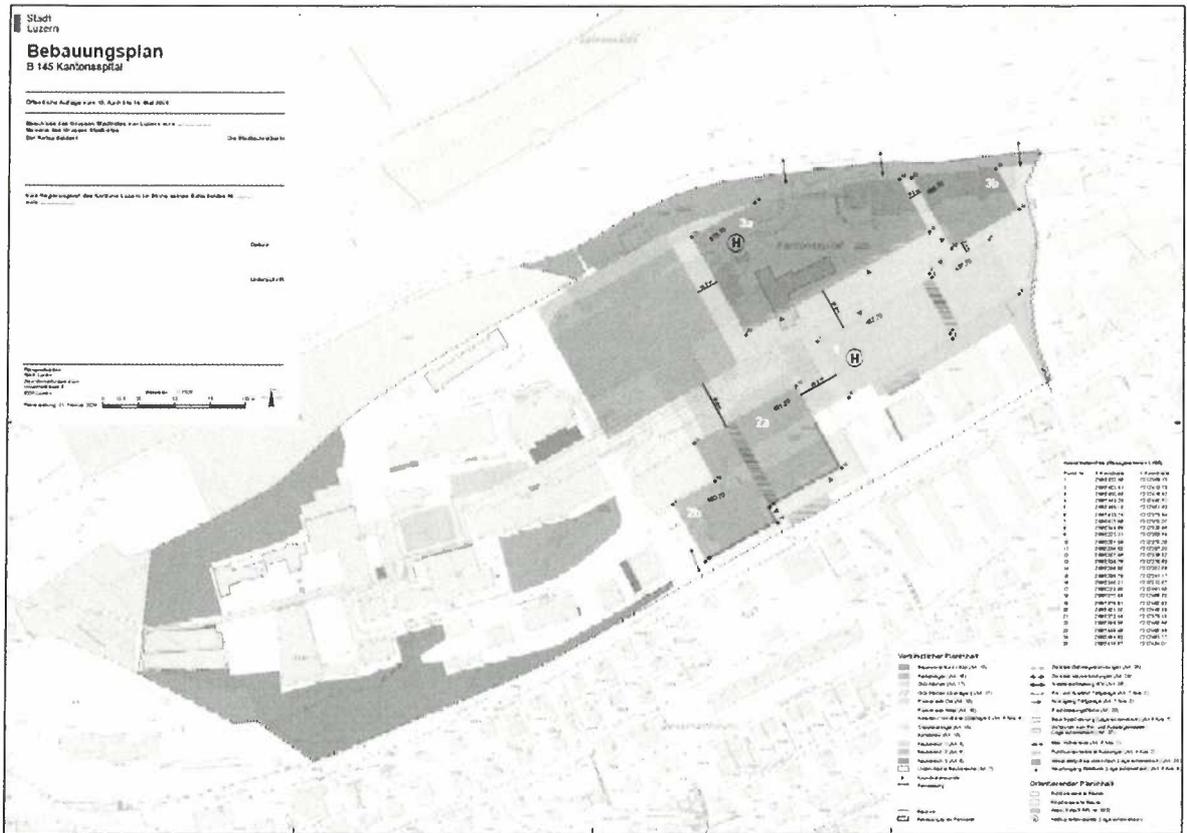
Entwurf des Bebauungsplans B 145 Kantonsspital gemäss B+A 40 vom 25. September 2024
